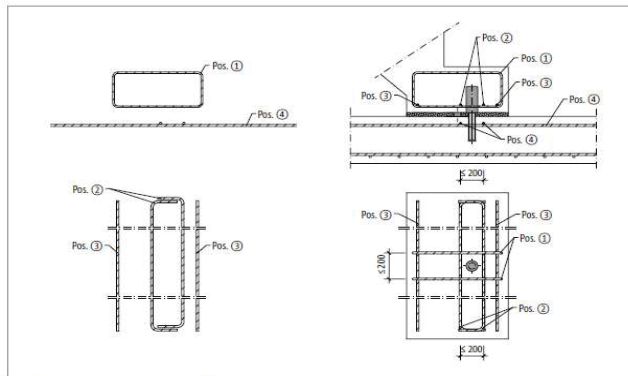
Schöck Tronsole® Typ D: Bauseitige Bewehrung
